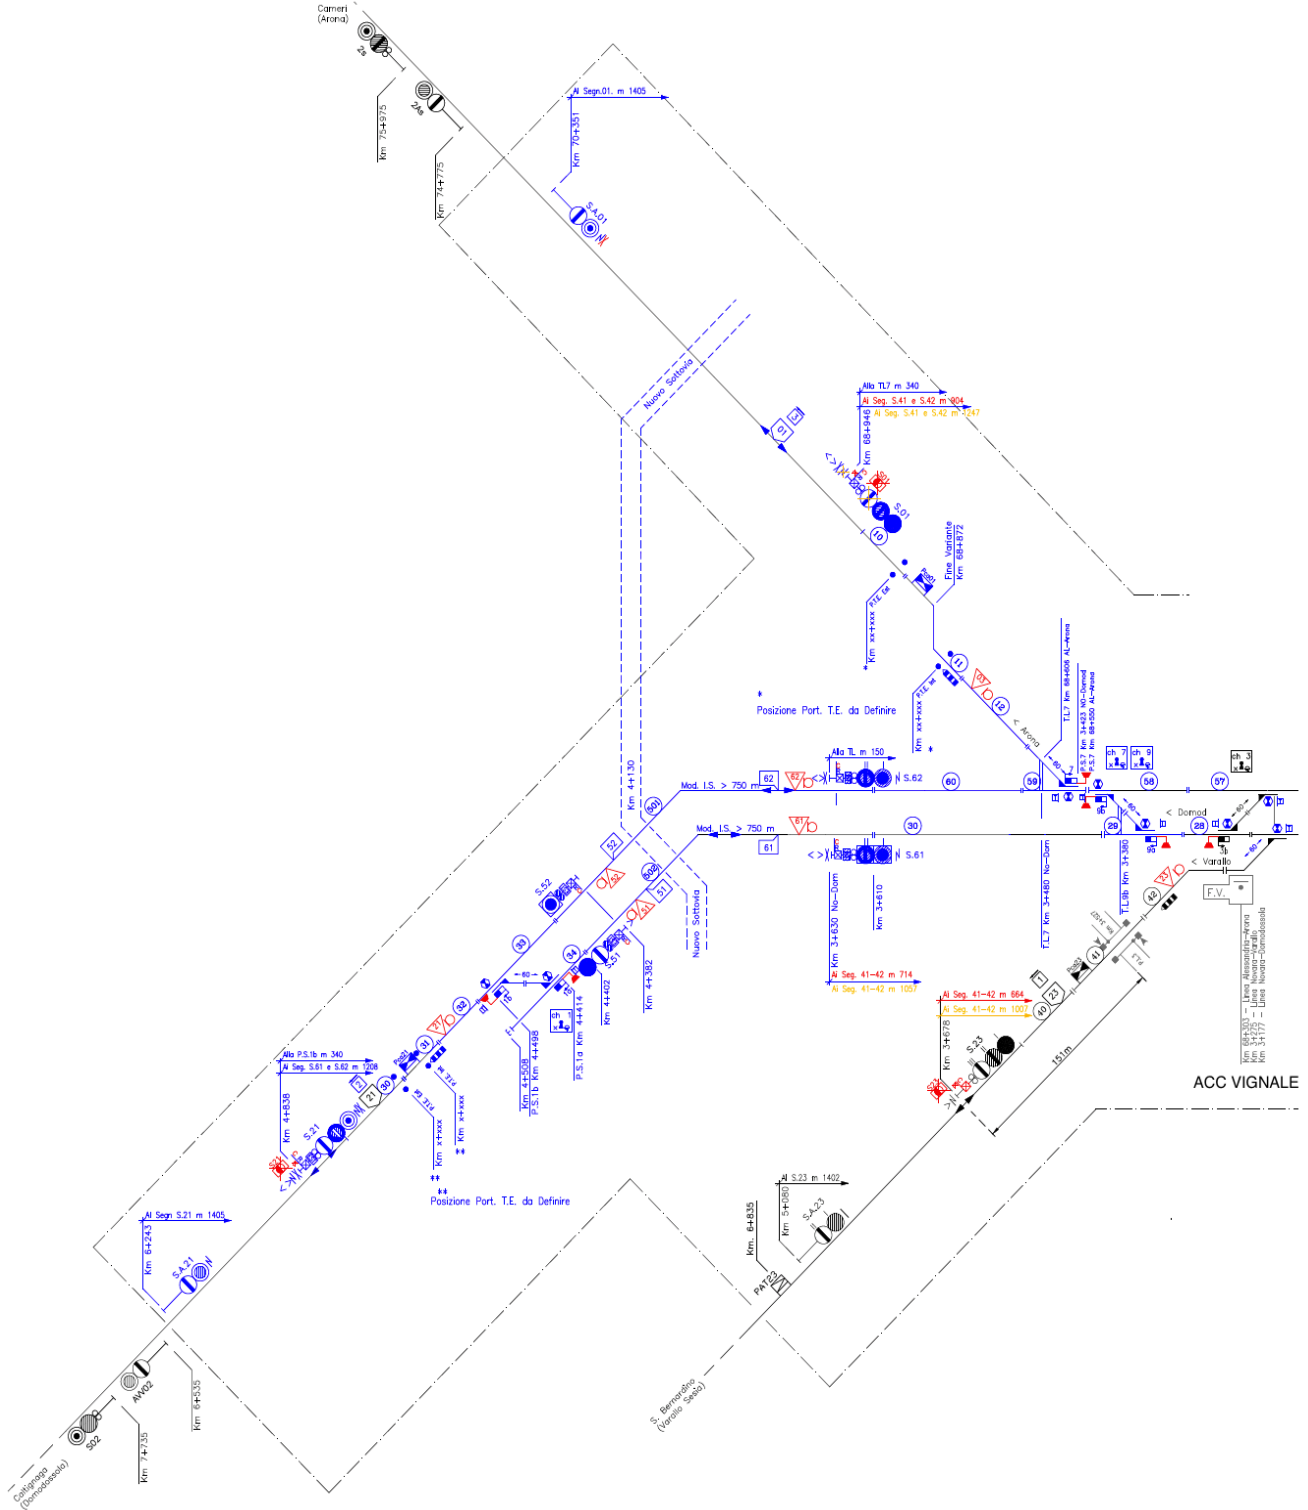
PIANO SCHEMATICO IS DI PROGETTO - VIGNALE
